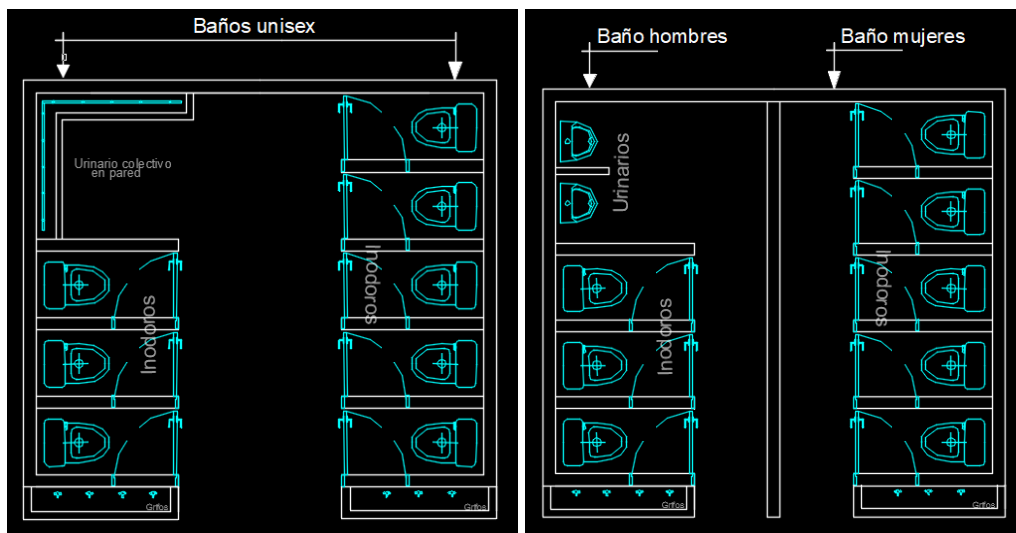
Plano arquitectónico actual y futuro de la batería principal color blanco frente a las escaleras del bloque 2. Fuente: autoría propia
